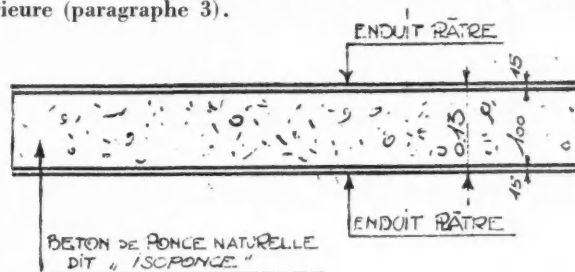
Coupe horizontale d'une paroi « composée » pleine (pan de béton-ponce, enduit sur 2 faces).
